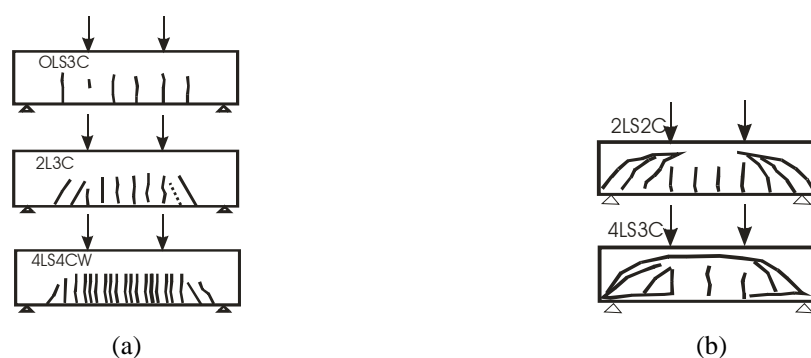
Configuração das fissuras nos painéis estudados por Saleem *et al* (1991)¹.
